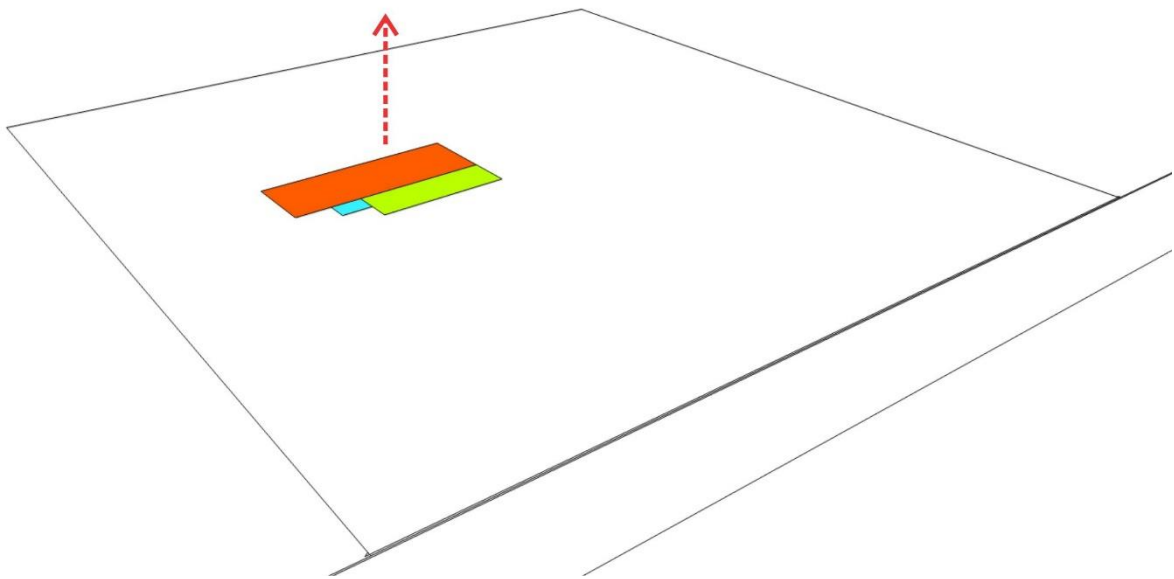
PLANTA DE ZONIFICACIÓN AUTOR M.Q.R.,
